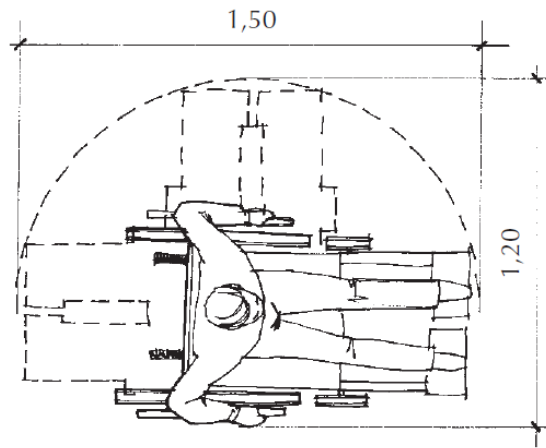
Espaço mínimo para giro de 180° (SMPED, 2008).
